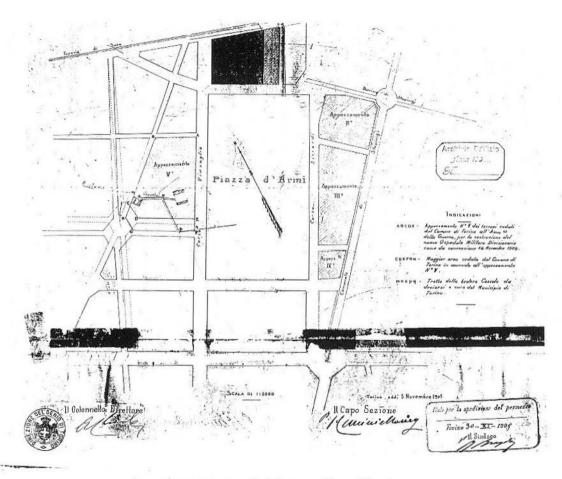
Planimetria della nuova Piazza d'Armi.
